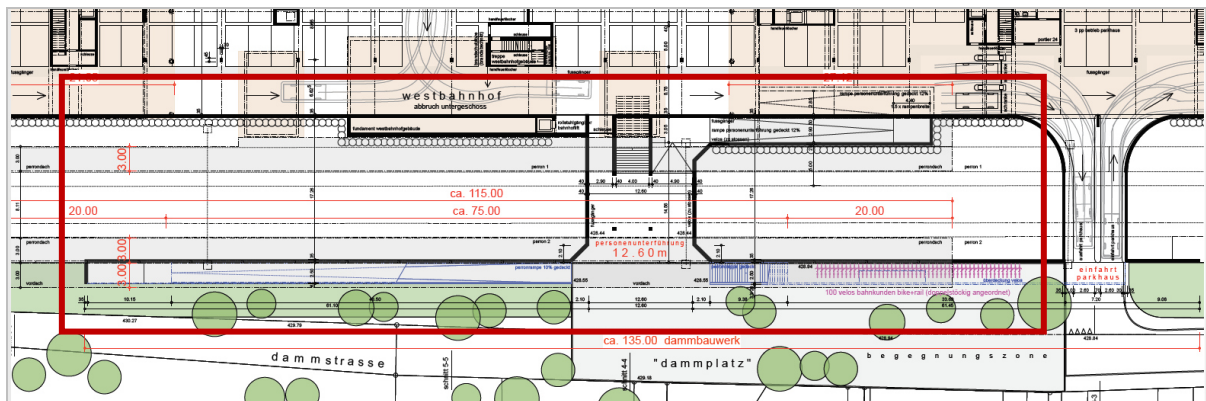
Grundriss mit Personenunterführung und Rampe, mit Zugang von der Seite Dammstrasse. (Rechts im Plan ist die Zufahrt Parkhaus).
